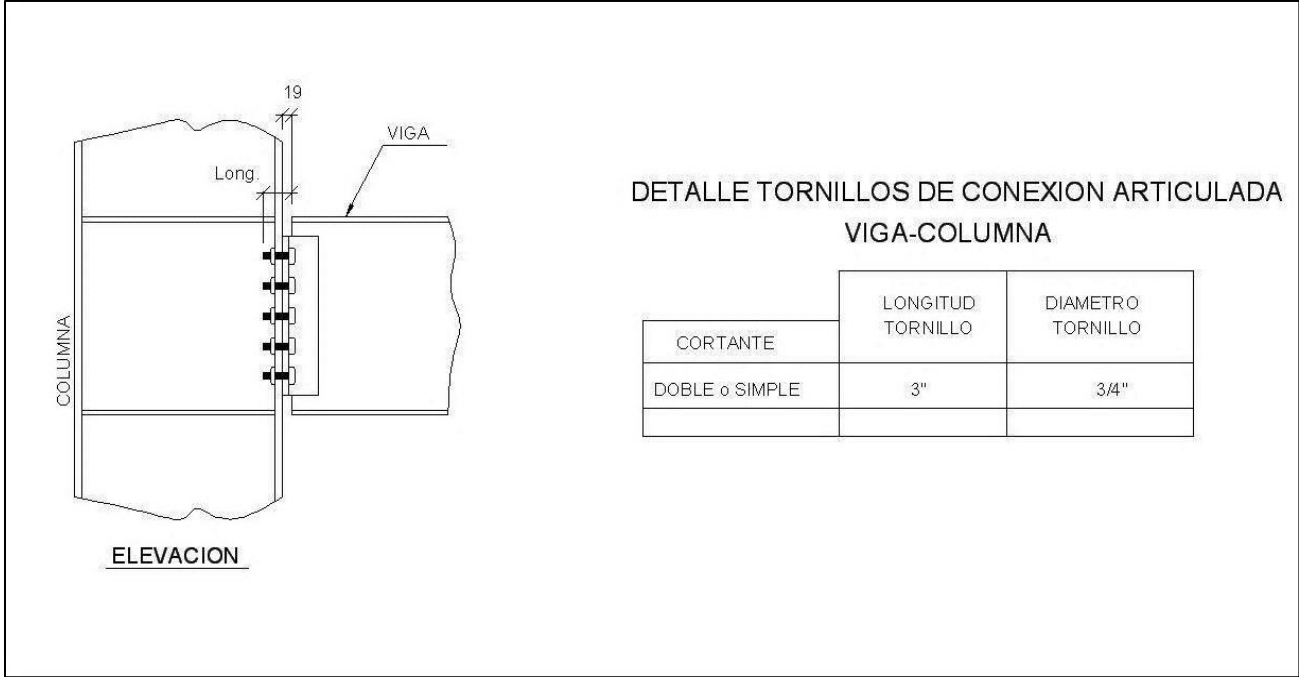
Detalle de montaje de conexión atornillada columna-viga
